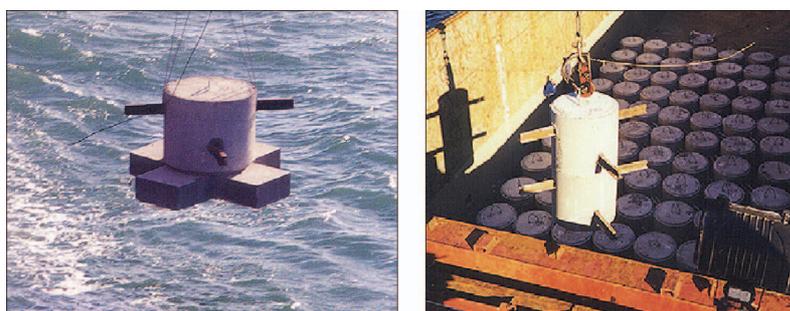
Estructuras de hormigón con elementos de disuasión
